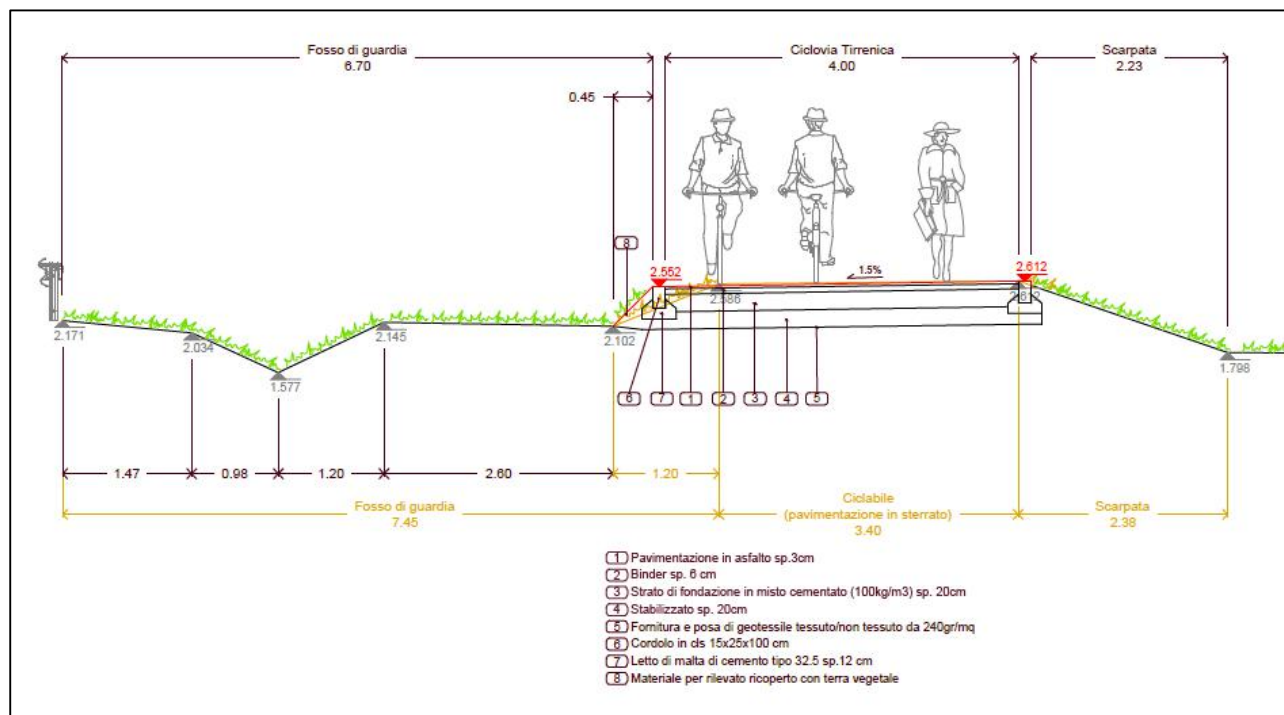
Sezione 20 di progetto trasversale SP delle Collacchie
